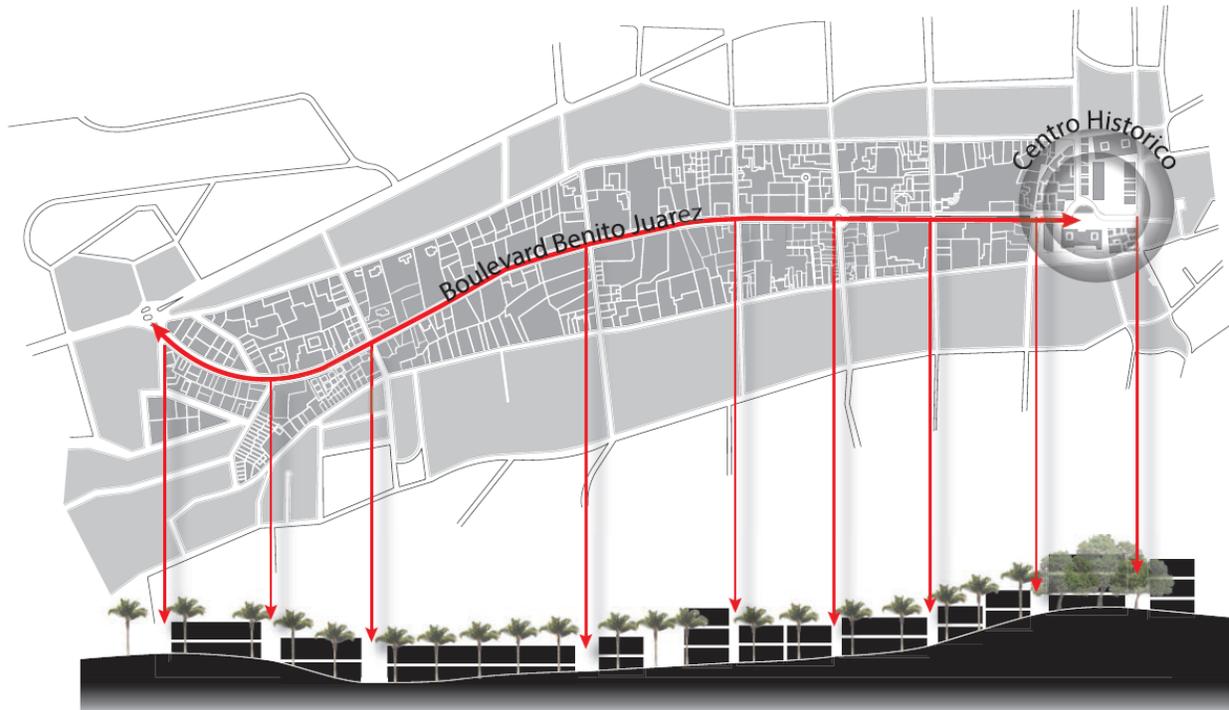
Topografía, corte longitudinal sobre el boulevard Benito Juárez.
